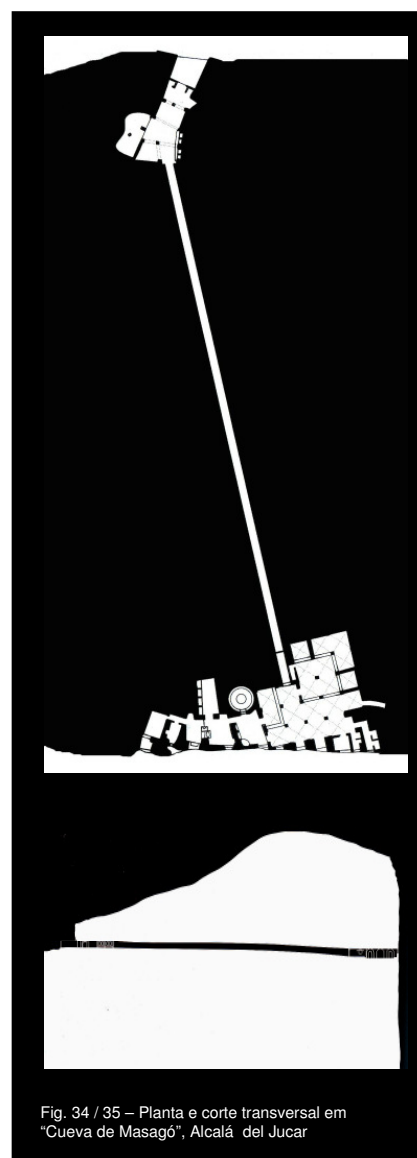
/ 35 – Planta e corte transversal em “Cueva de Masagó”, Alcalá del Jucar
